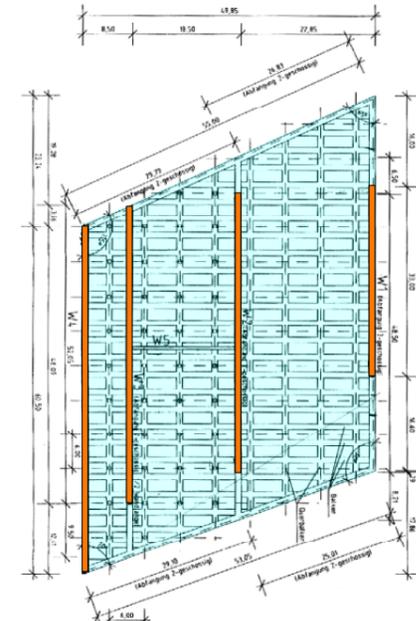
Grundriß Abfangungsebene mit lastabtragenden Scheiben
